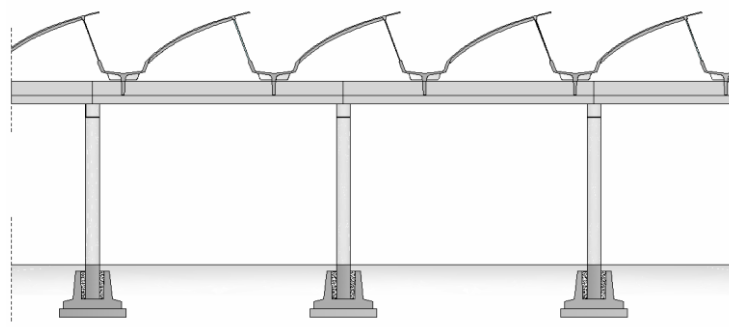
Exemplo de cobertura de elementos de casca apoiadas em vigas R [12]
